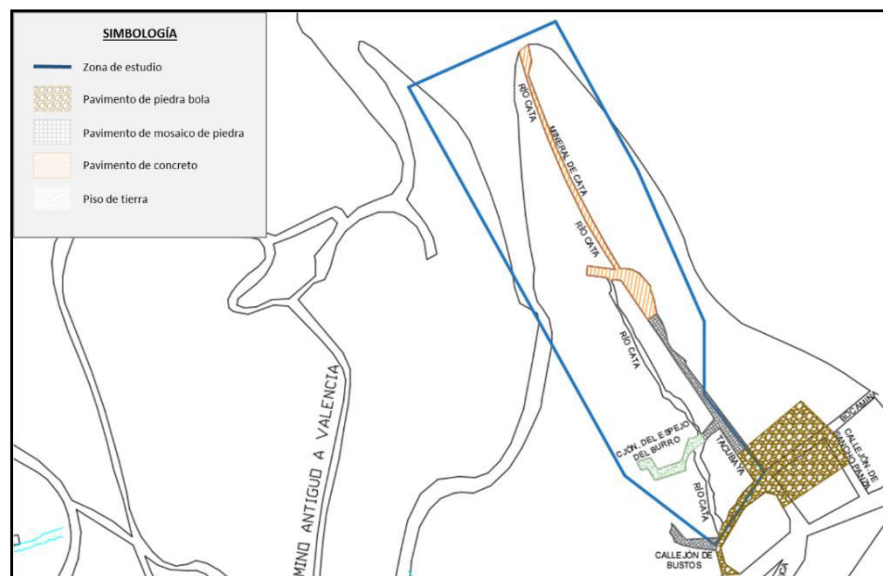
Tipos de pavimentos en la zona de estudio. Elaboración propia.
